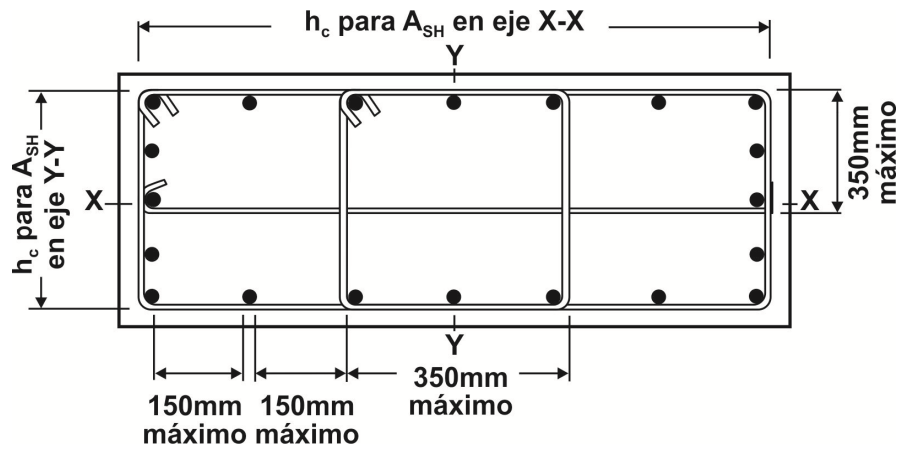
4: Detalles de Estribos en Columnas
